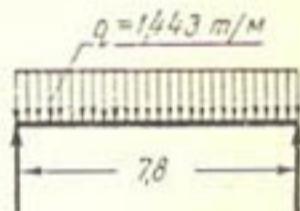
Расчетная схема нагрузки лотка в продольном направлении.
